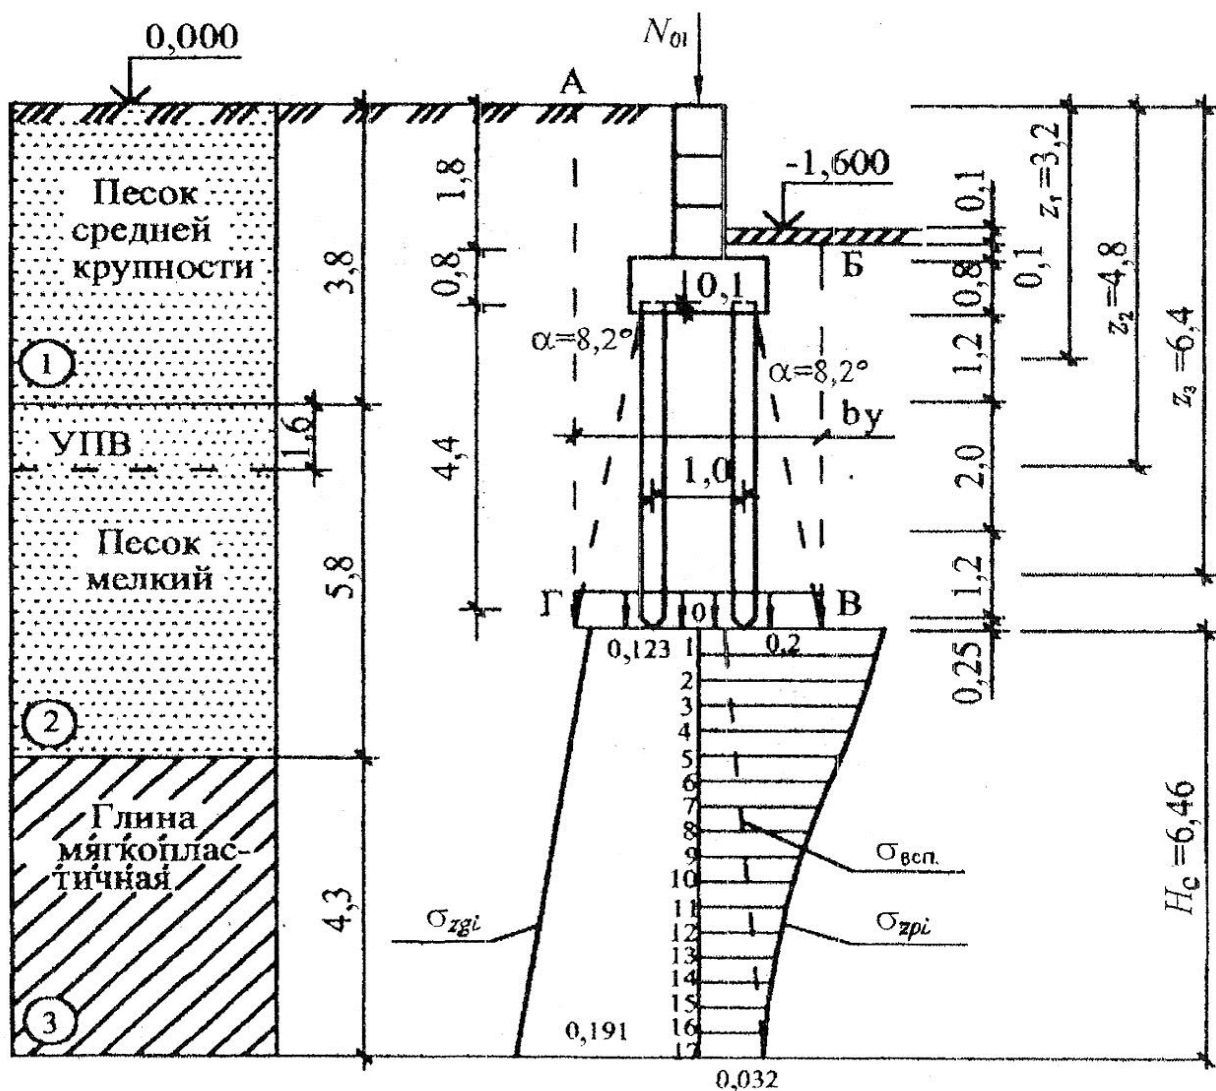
Расчетная схема к проверке напряжений и осадок свайного фундамента
